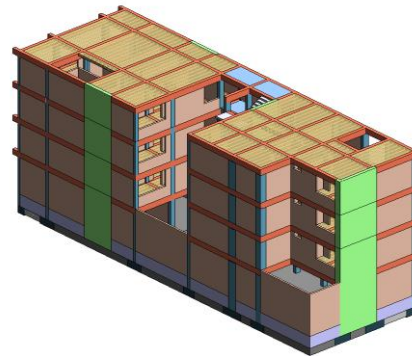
Modelado 3D de la vivienda rediseñada en Revit 2025
